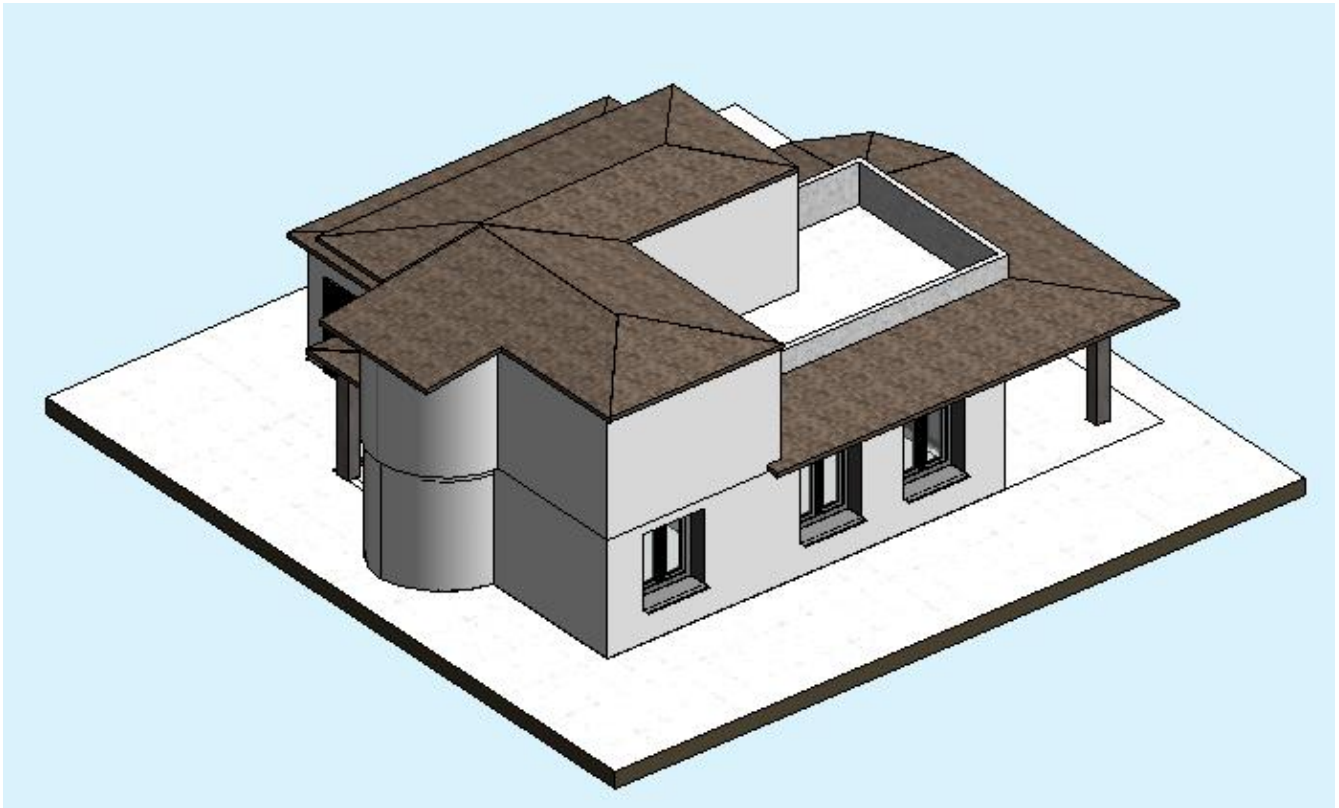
Modelado del proyecto “Chestre 68” con Autodesk® Revit™2016. Alzados Norte y Oeste
